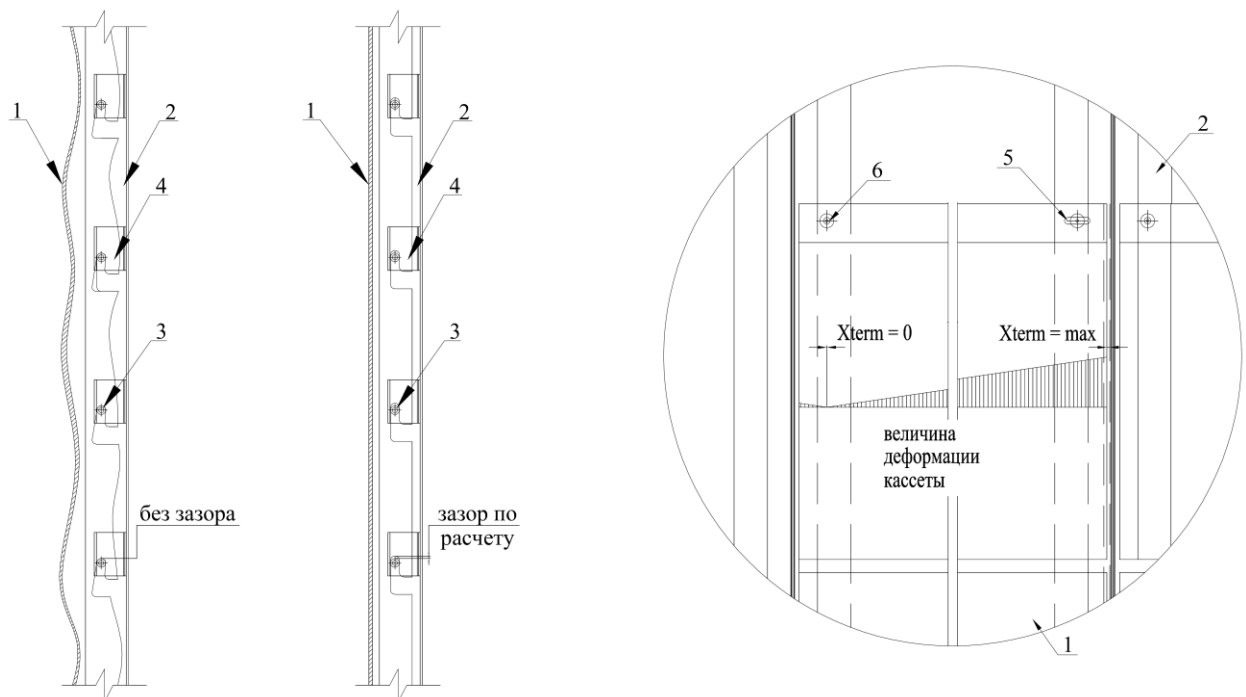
Схема установки кассеты с вырубленными проушинами
